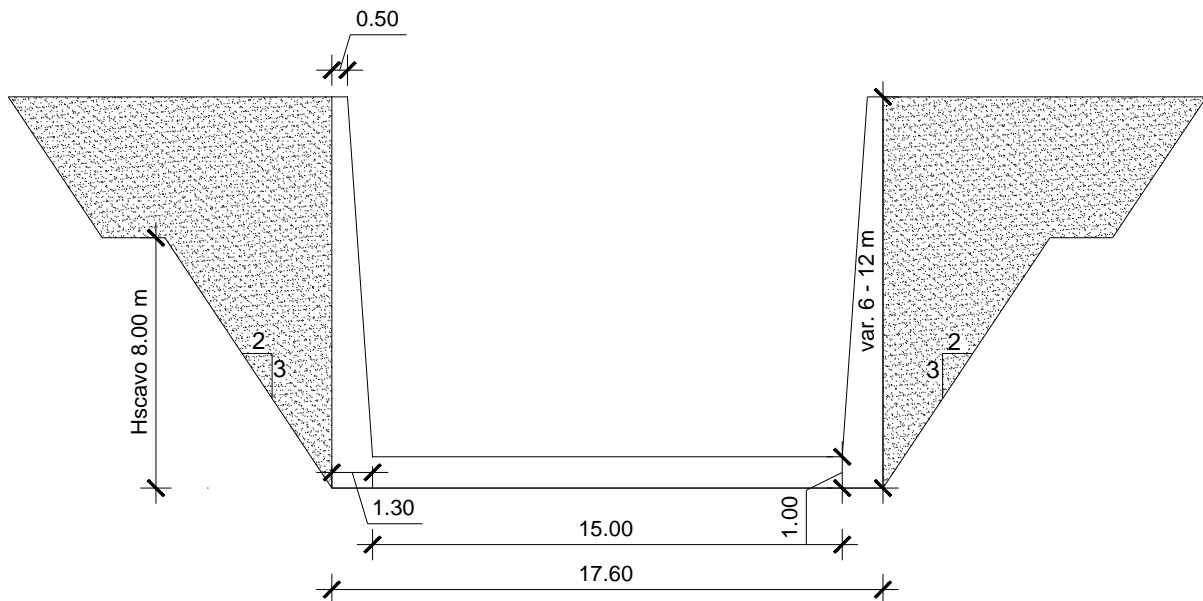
Sezione trasversale tipo dei muri d'imbocco.
